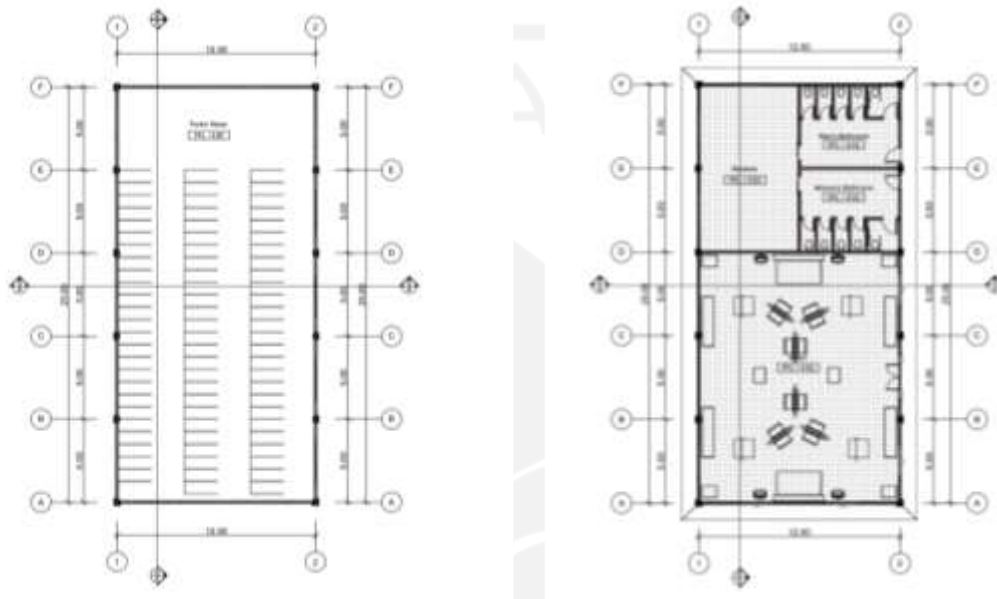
Denah Basement dan Lantai 1 Cafe
